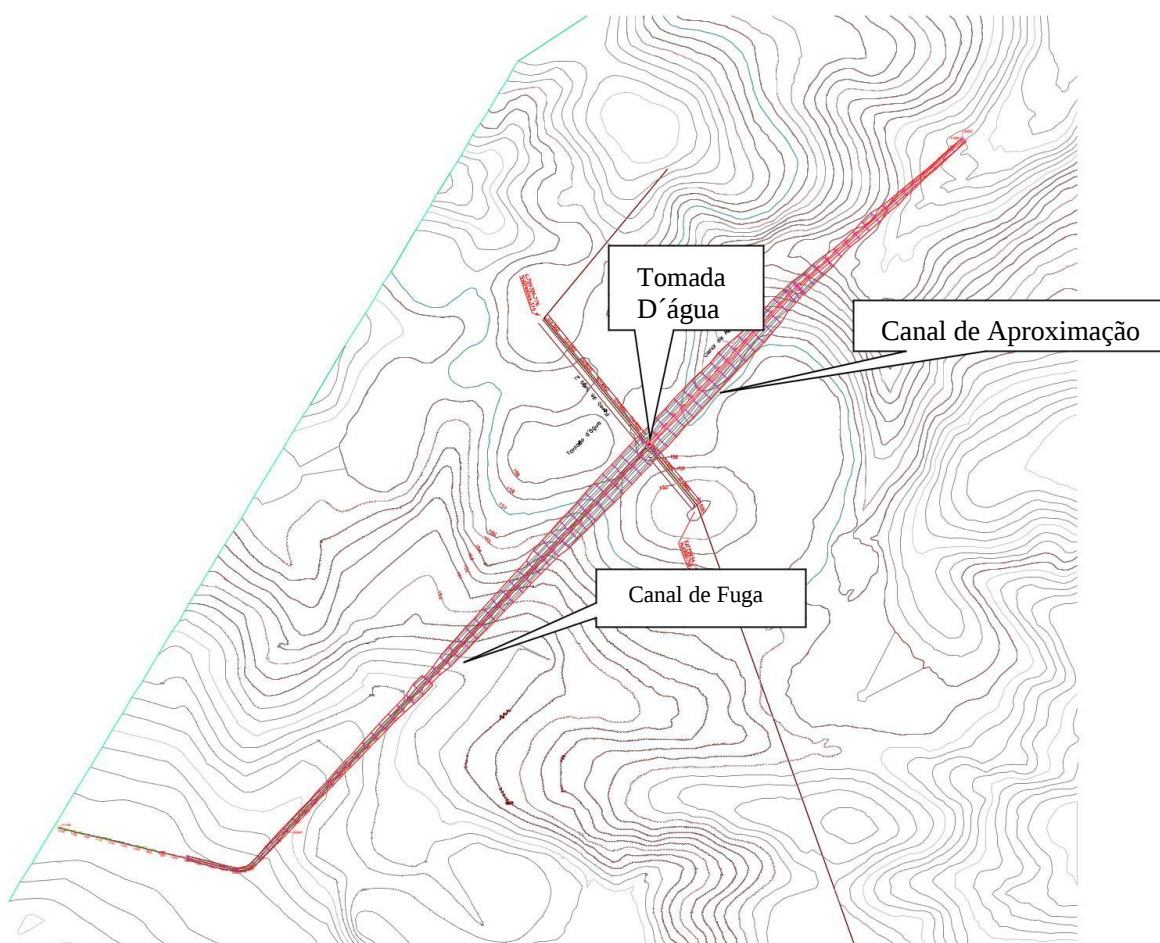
Arranjo Geral das Estruturas – Vista Geral
